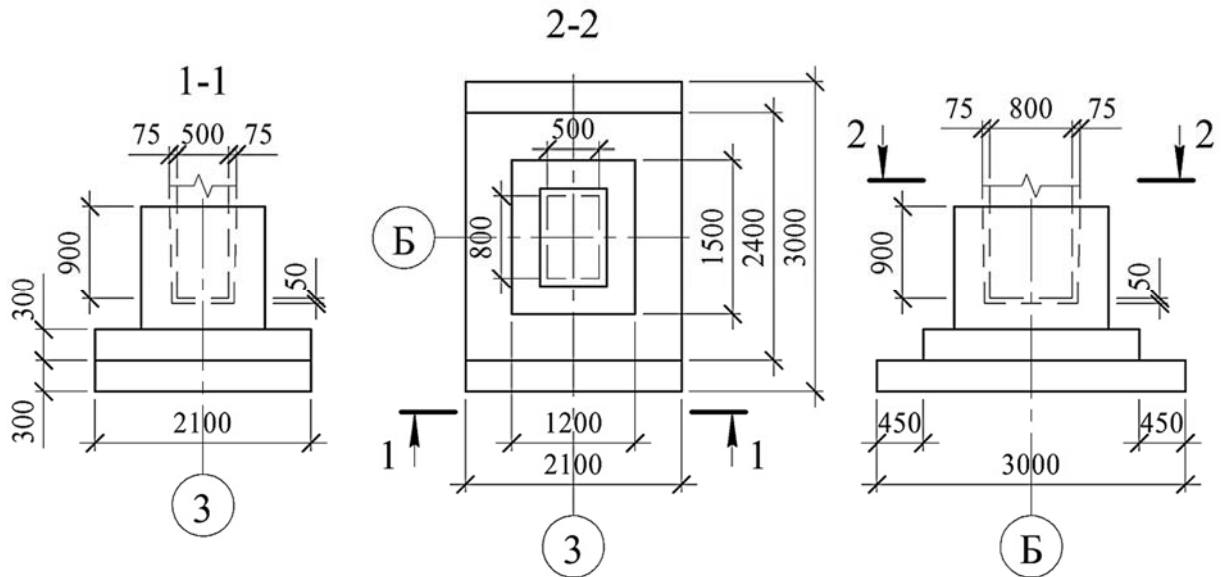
Конструктивная схема фундаментов, расположенных по средней оси
